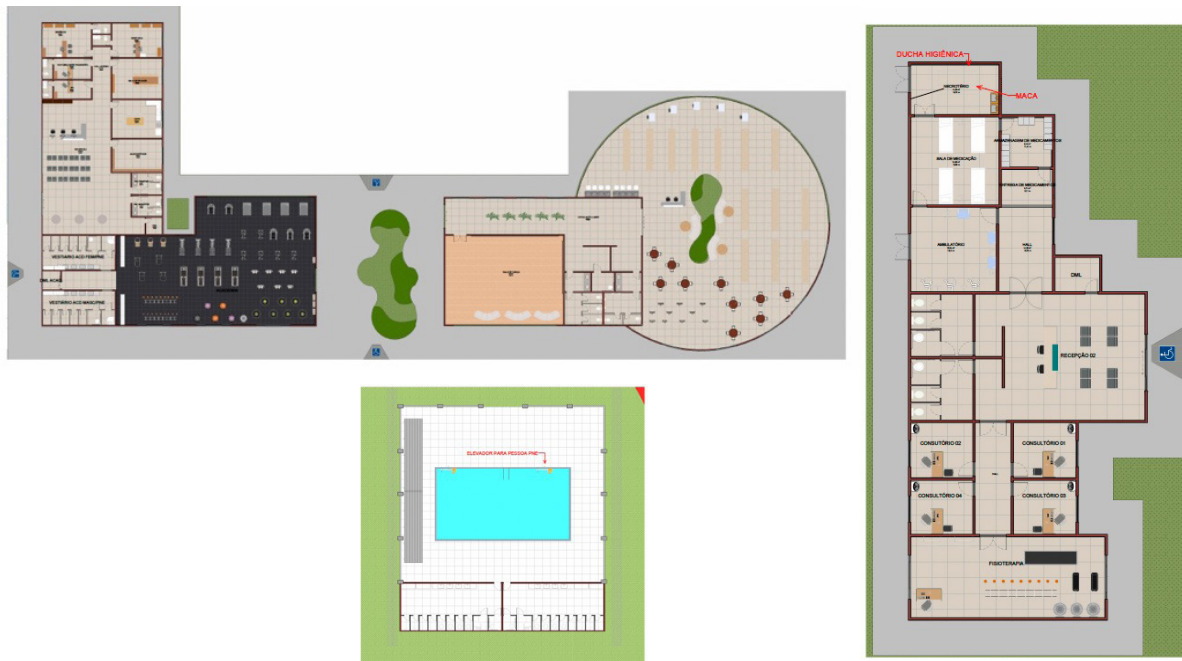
Planta de Layout 1 Fonte: Autoras, 2023
